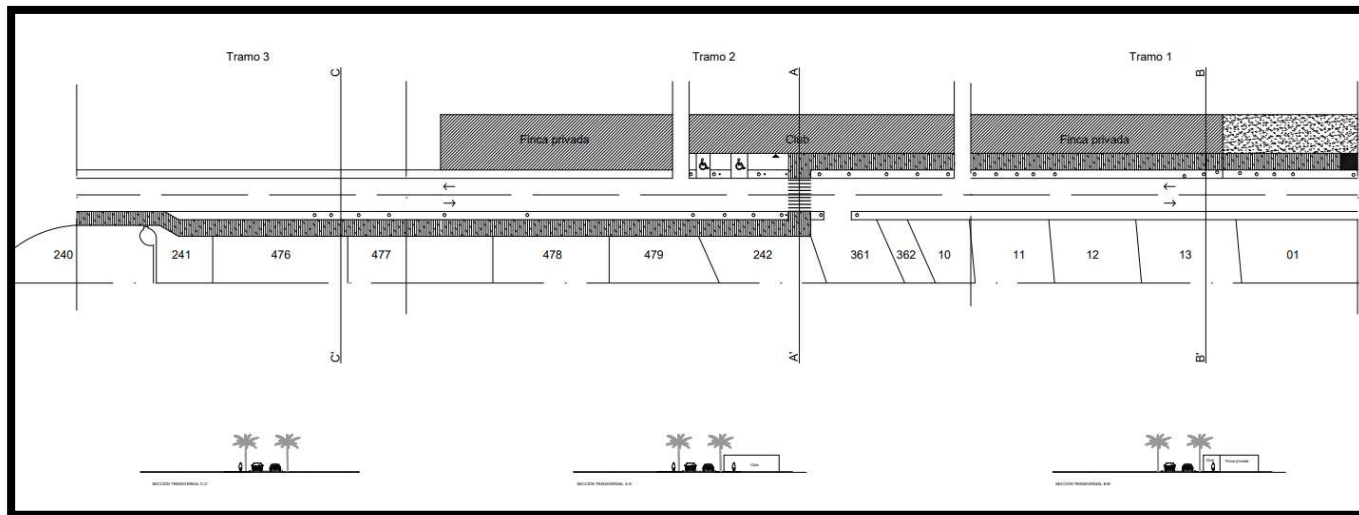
Secciones transversales. Fuente: Elaboración propia
